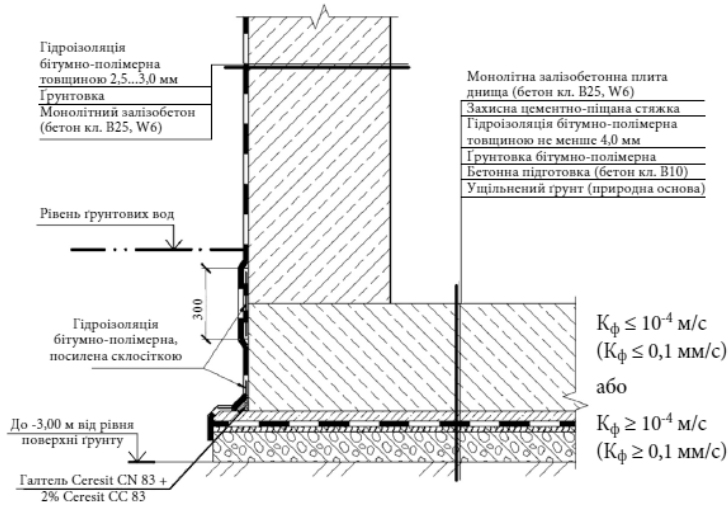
Гідроізоляція бетонних плит основи і стін підземних споруд в умовах впливу ґрунтової води під тиском.
